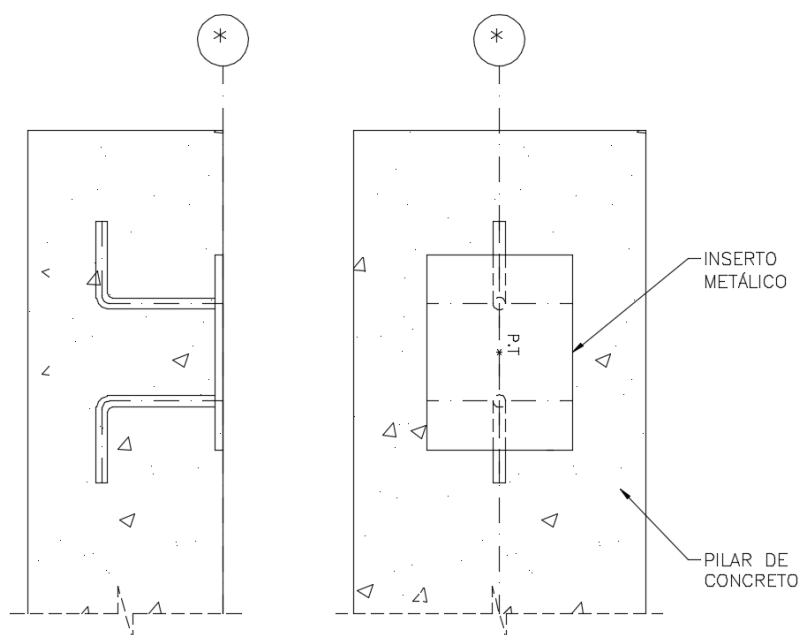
Detalhe típico de chumbação para base pilar metálico.
